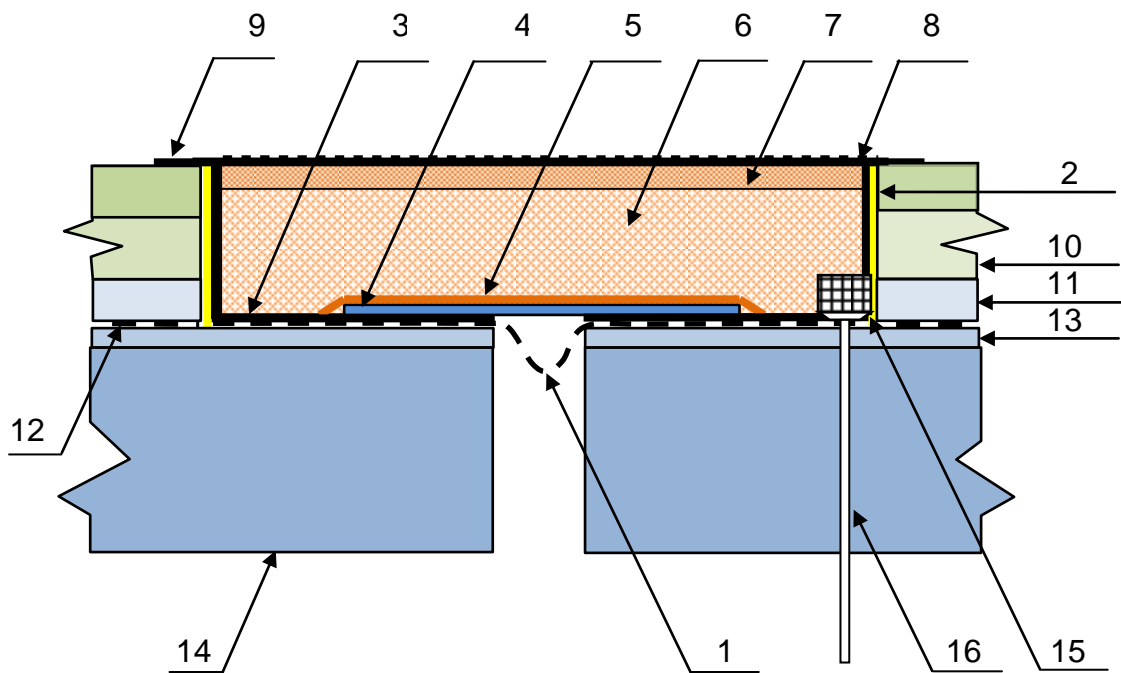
Рекомендуемая конструкция ЦМДШ при поврежденном слое гидроизоляции и защитном слое
